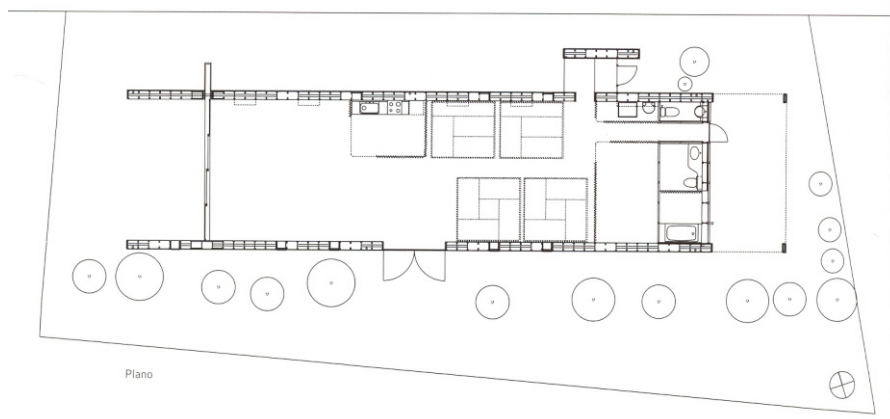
planta da "Naked House" onde se pode ver uma das possíveis distribuições do "open-space"
